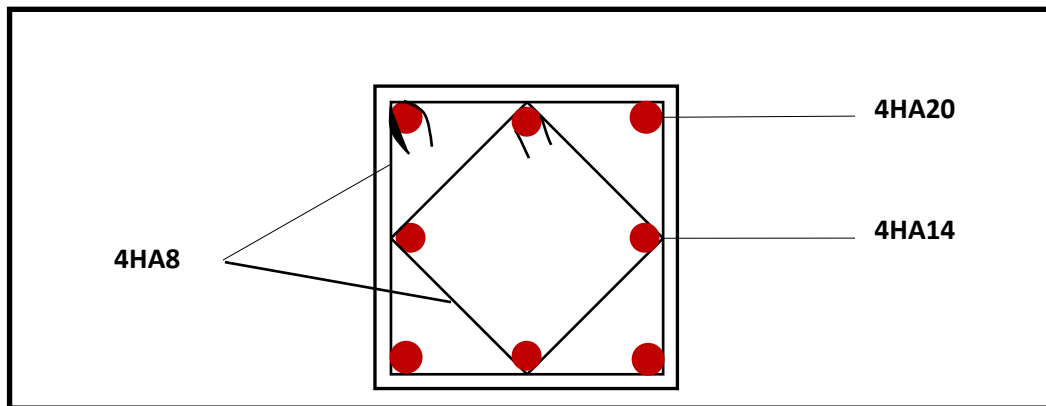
Schéma de ferrailage du poteau 45x45.
